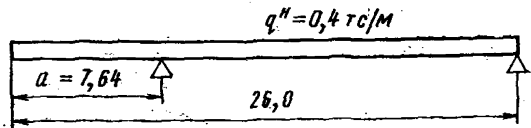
Расчетная схема для определения усилий в свае длиной 26 м во время монтажа
